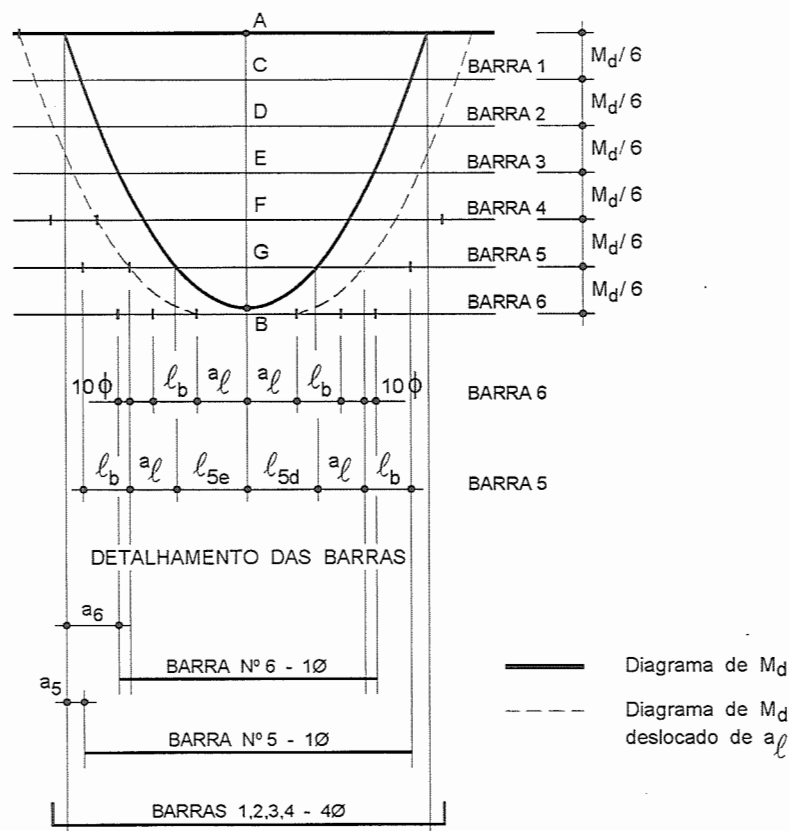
Exemplo de detalhamento de barras da armadura longitudinal em vigas
